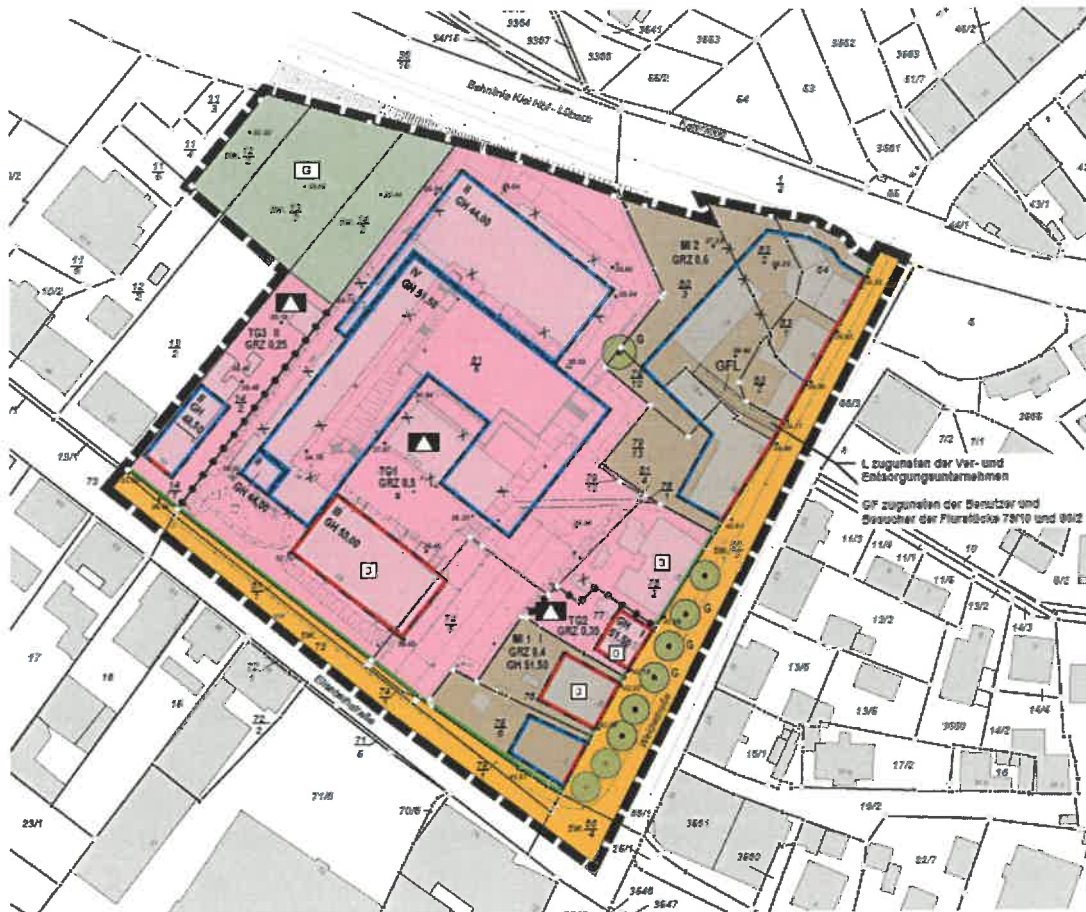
Bebauungsplan Nr. 150 der Stadt Eutin – Planzeichnung (PROKOM, Stand: April 2022).
